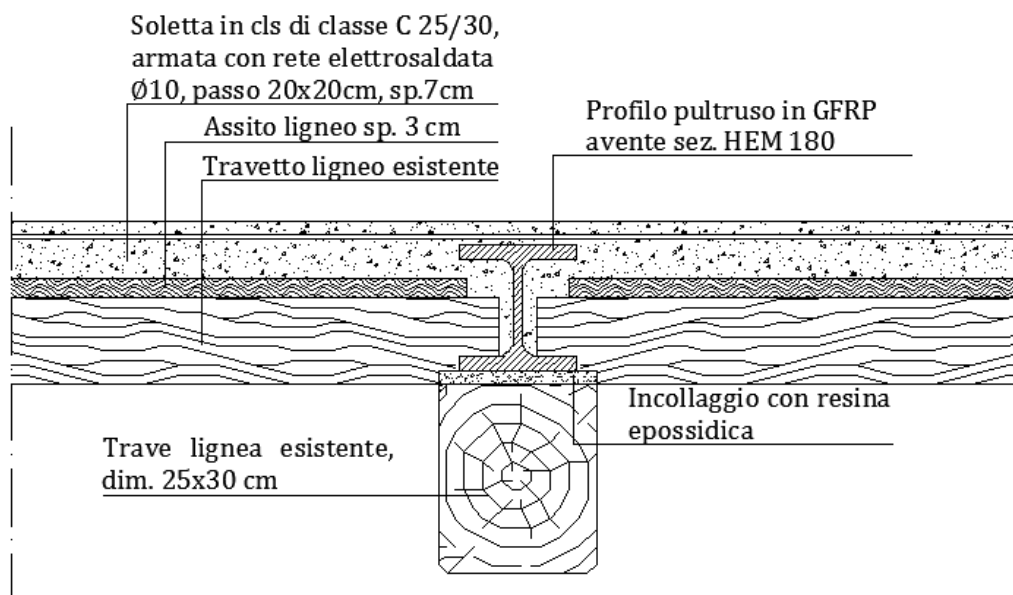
Rinforzo della trave lignea con profilo pultruso in GFRP incollato all'estradosso
